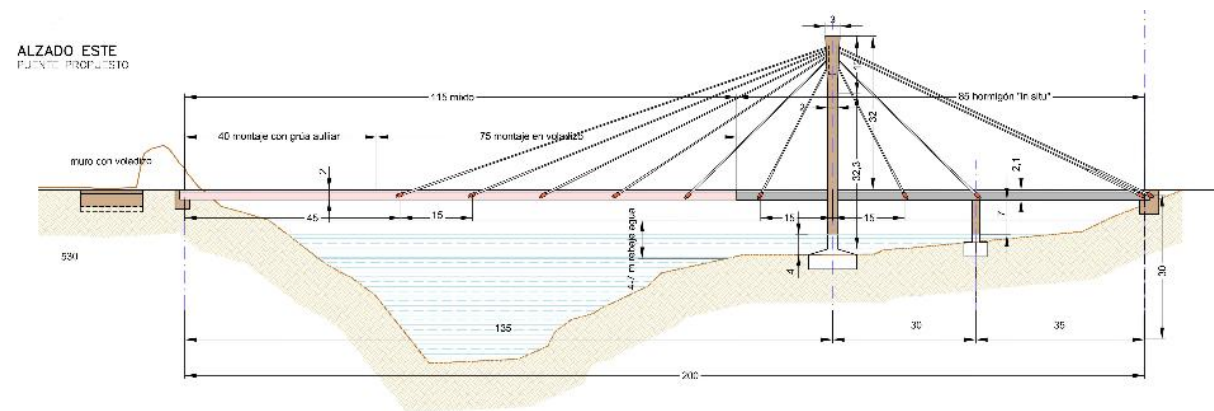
Planta general y alzado este puente atirantado con dos apoyos
